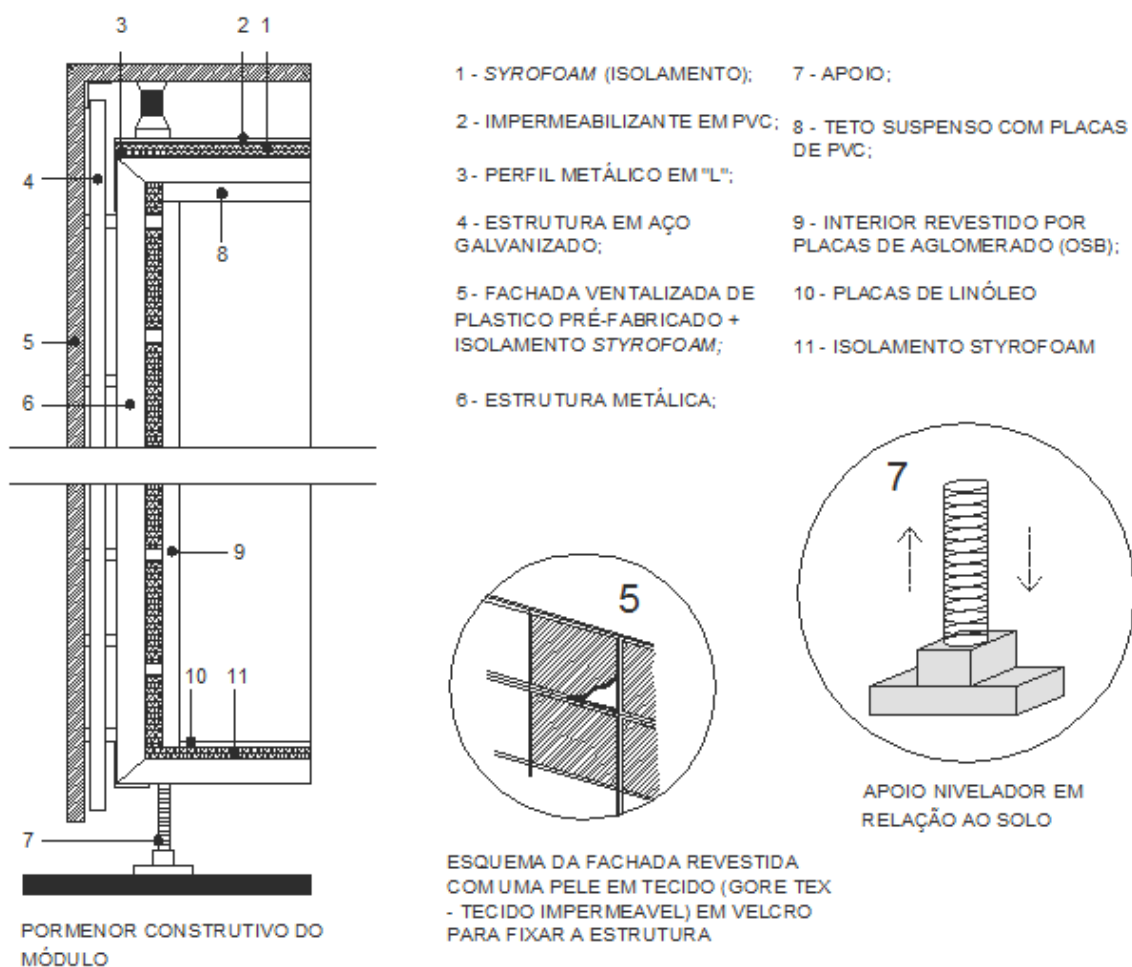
Esquema do pormenor construtivo da estrutura principal.
